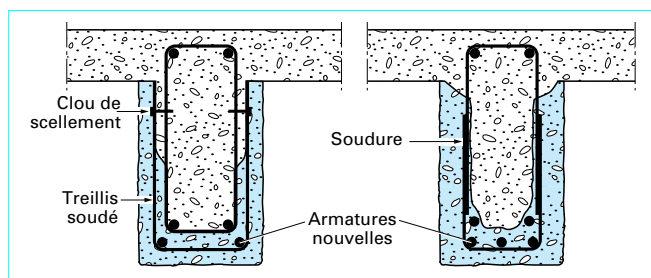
Armatures supplémentaires en surépaisseur de poutre
